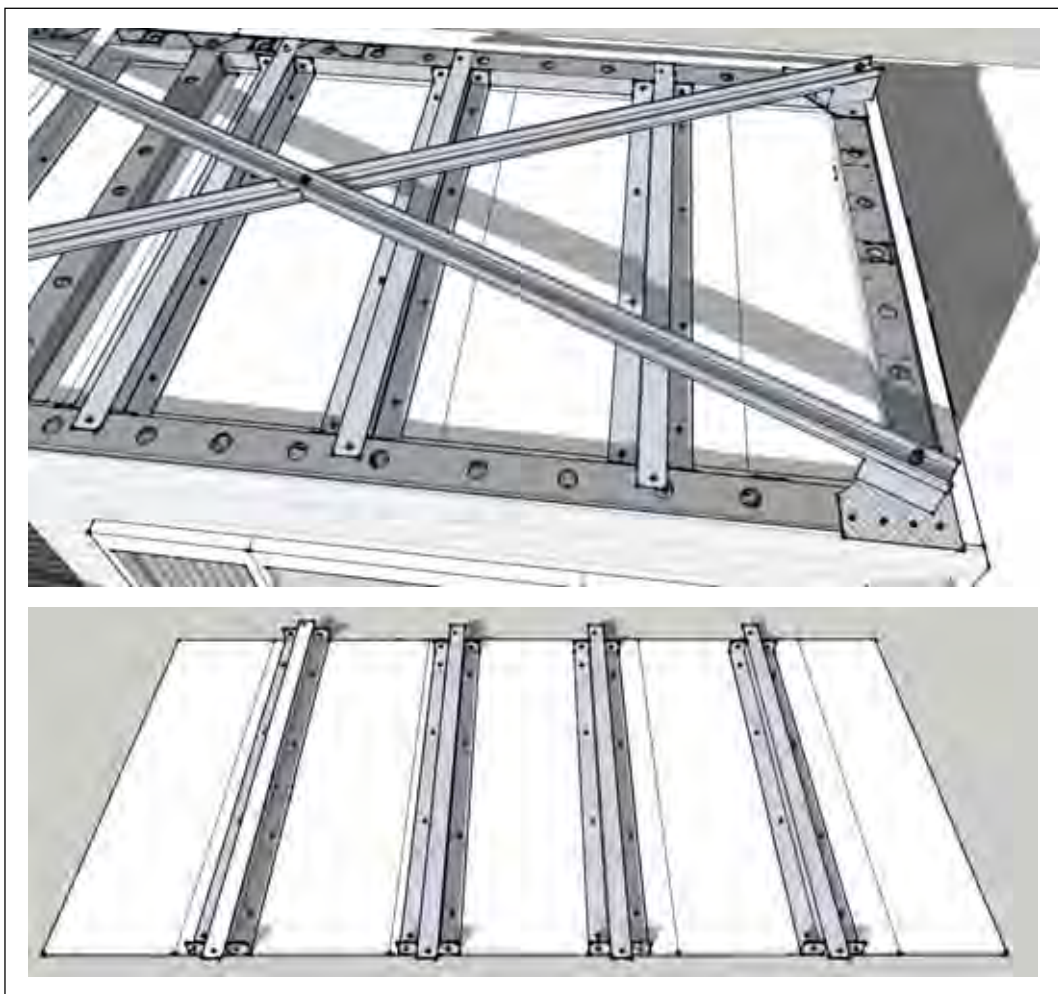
Colocación del plafón. Fuente: Elaboración propia 2008
